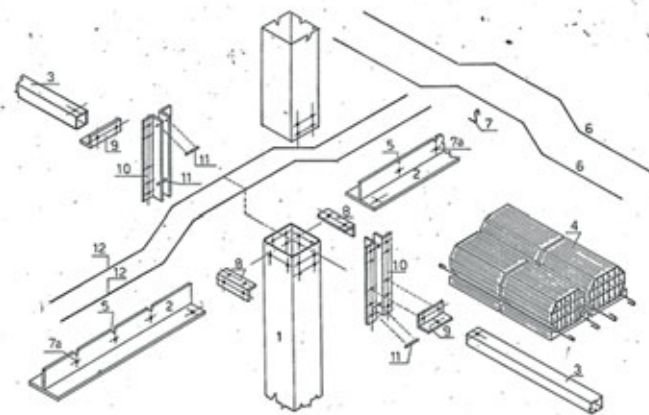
Seconda fase operativa del Centro Carpenteria Dalmine (1968-1976): il brevetto relativo a «elementi tubolari per la costruzione di impalcati» (Fondazione Dalmine).
